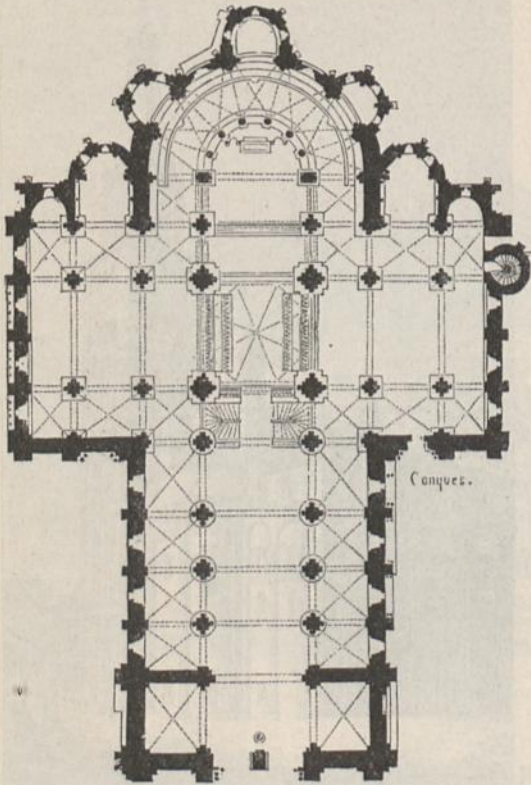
Grundriss der Abteikirche zu Conques.
